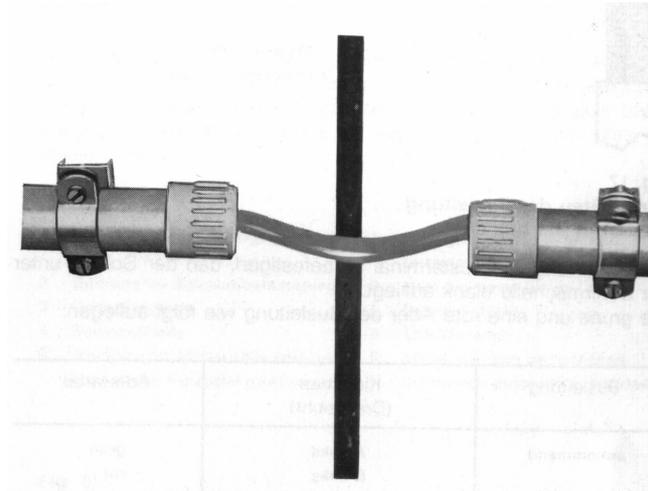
Unterbrechung des Schutzrohres an einer Dehnfuge
